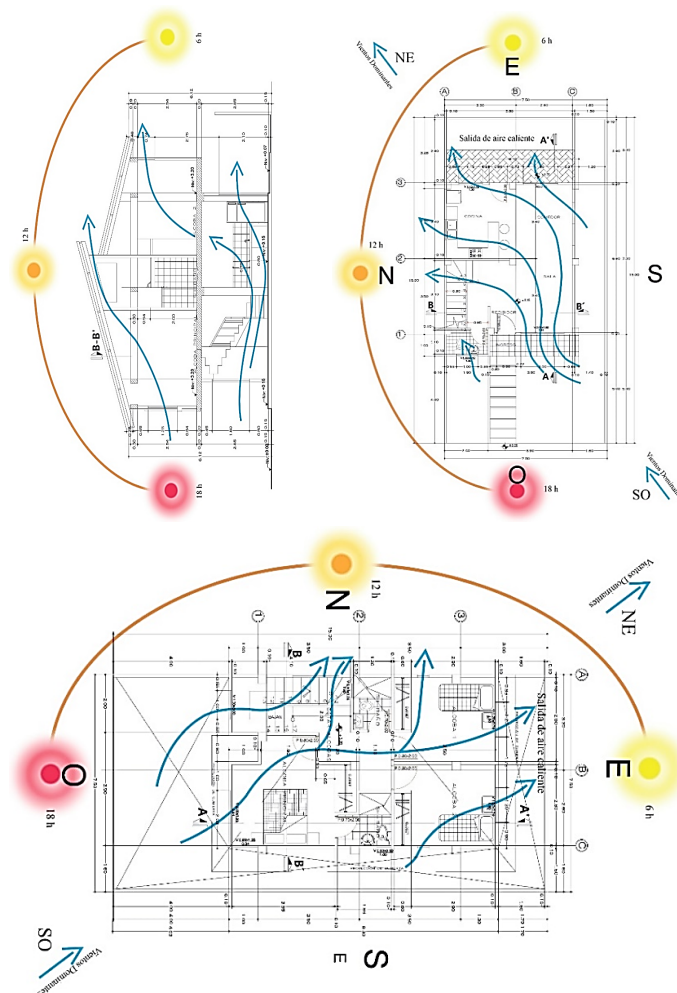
Planta baja y planta alta de prototipo de vivienda.
